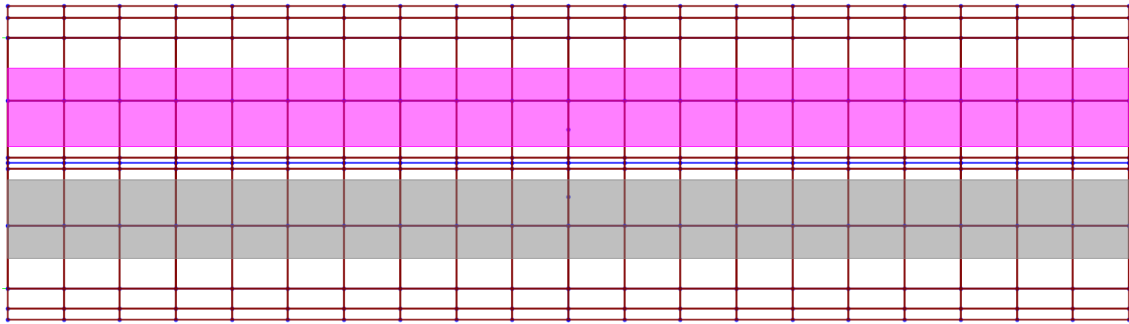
Vista en planta de los carriles sobre el tablero con la separación central
